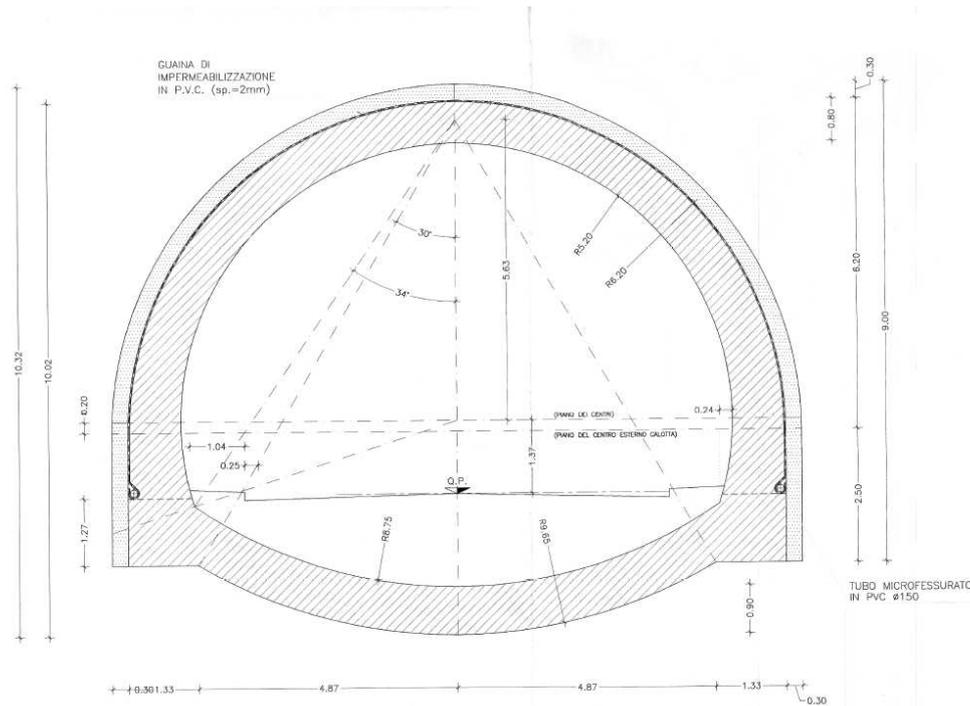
Galleria Valpiana – Sezione Tipo Va, Tipo Vb e Tipo Vb
